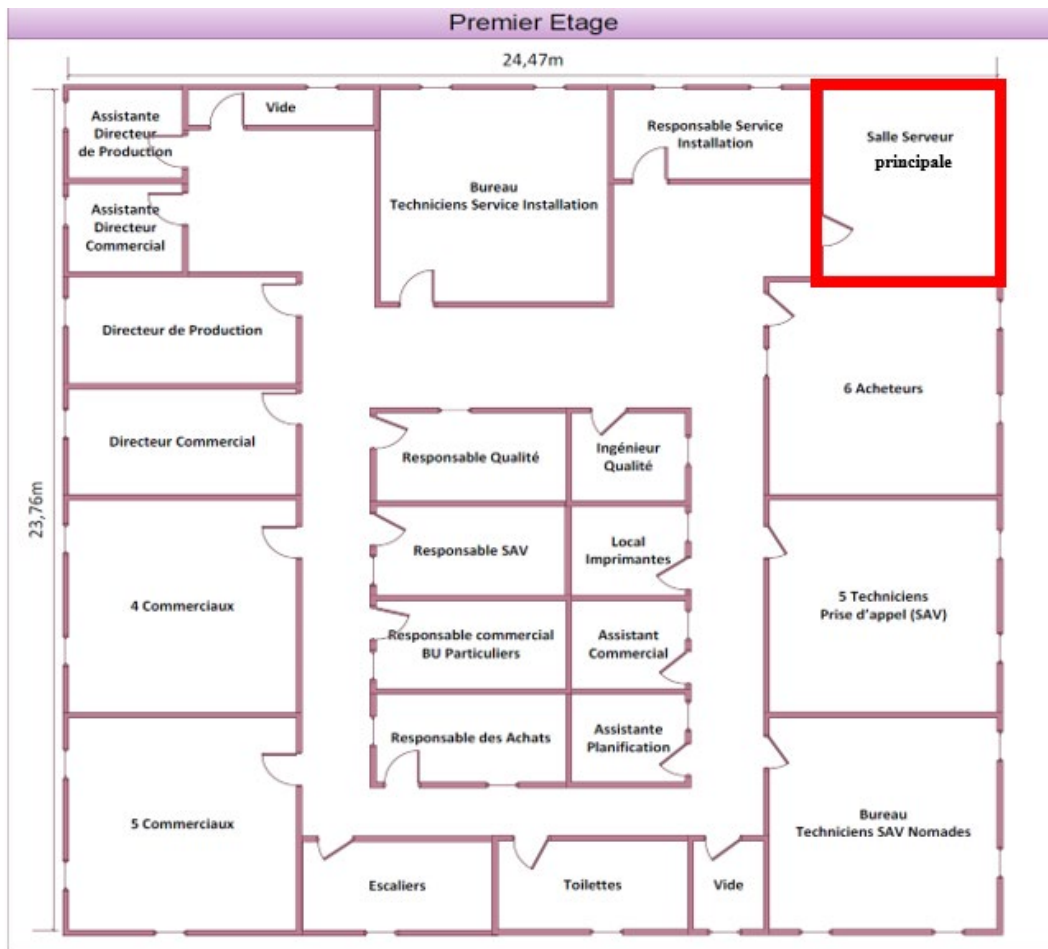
Plan d'implantation des serveurs à Lille 2/2
